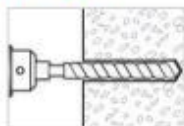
Detalhe da perfuração de 12,5 mm da parede de diafragma para ancoragem dos anéis de concreto.
